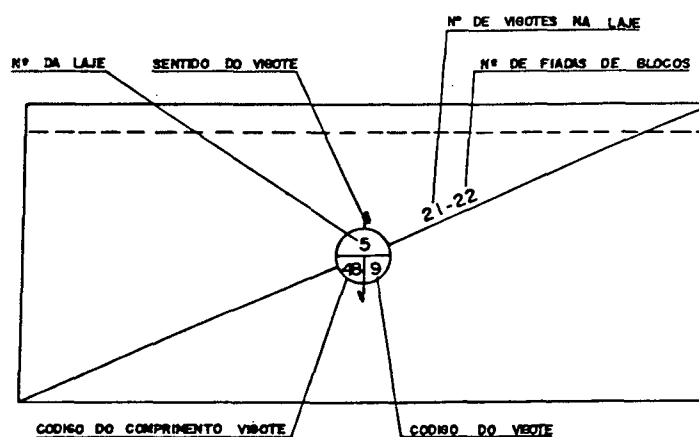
CODIFICAÇÃO PARA LAJE PRÉ-MOLDADA
